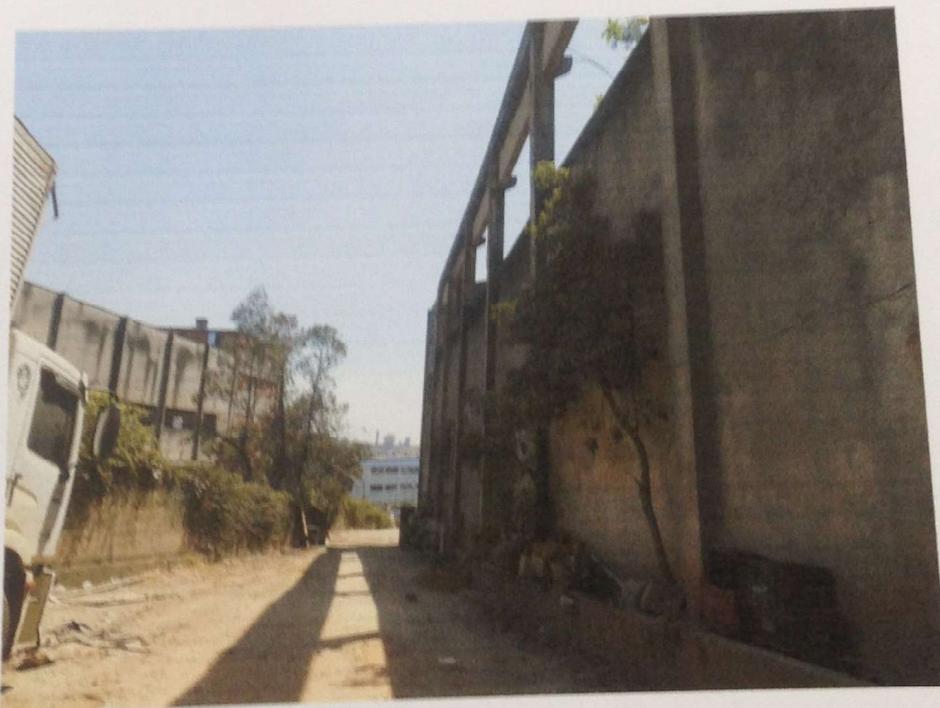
Parede que fazia parte de alguma construção que foi demolida.
